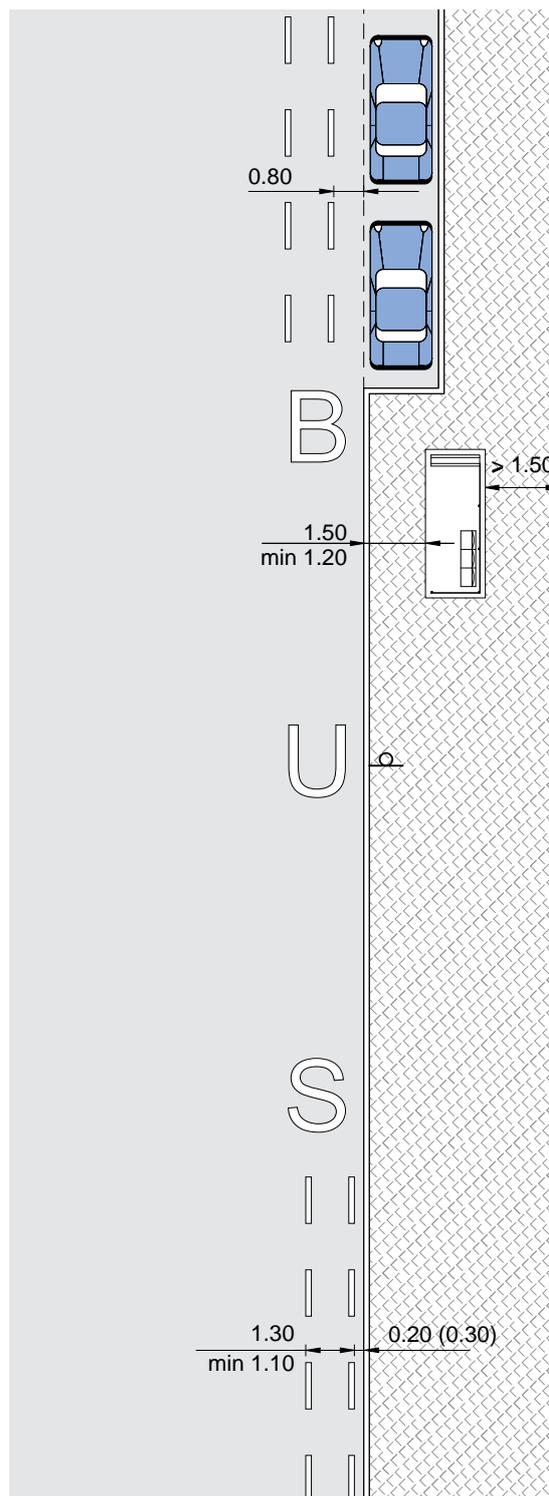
Piste cyclable séparée et arrêt sur la chaussée
